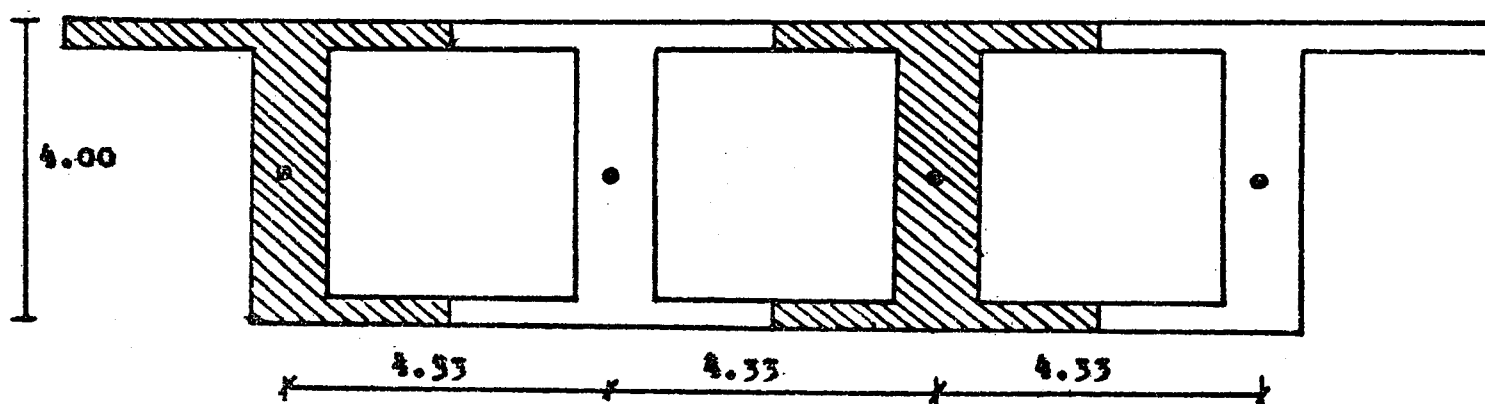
IDEALIZACION ESTRUCTURAL
